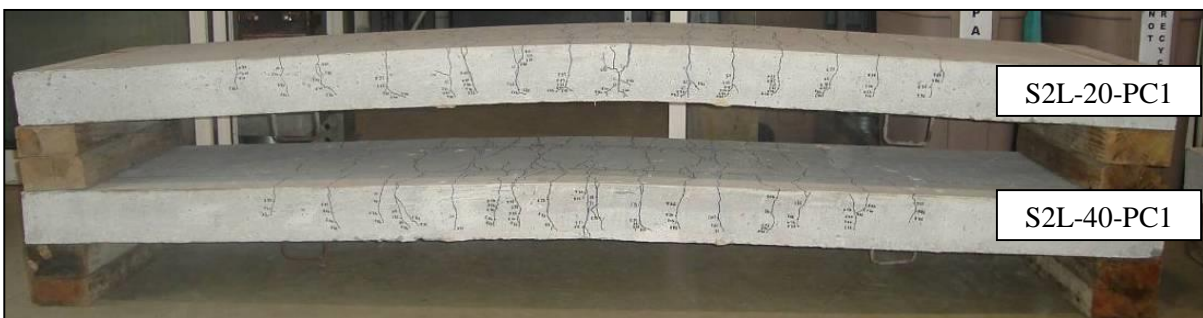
Pormenor da deformação final das lajes ensaiadas (posição das lajes invertida).
